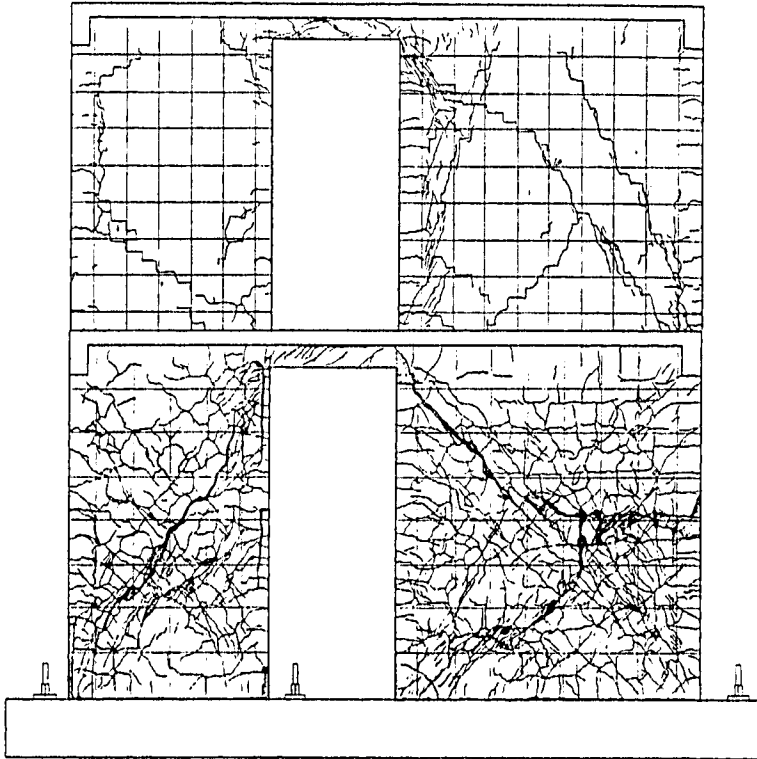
Patrón de Agrietamiento Final (Muro Norte)
